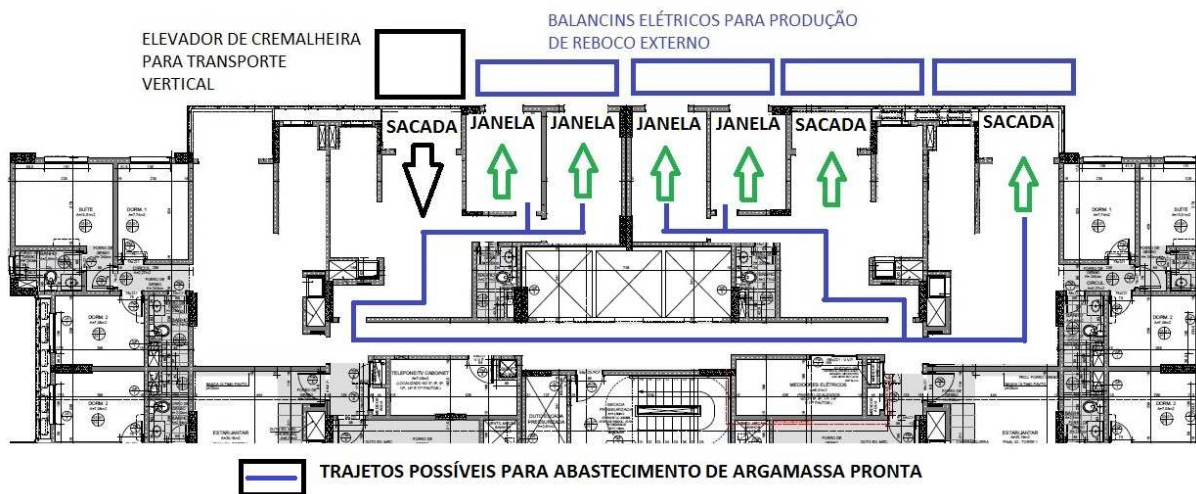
layout do abastecimento de argamassa pronta do pavimento tipo da torre
